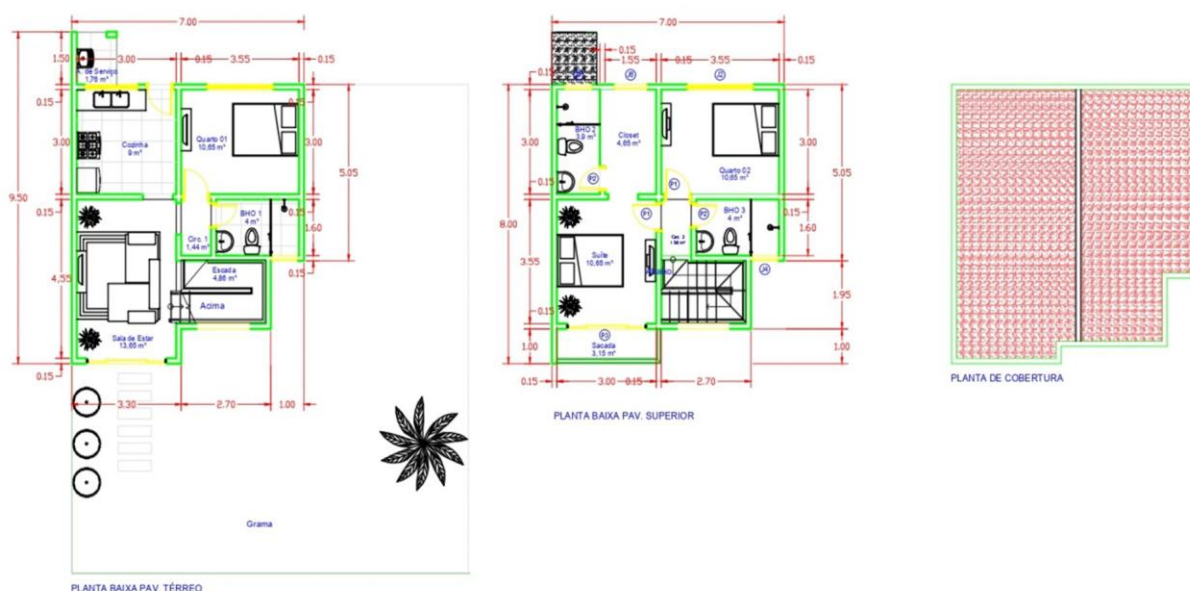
Planta baixa do pavimento térreo, pavimento superior e planta de cobertura. (Autoria própria).
